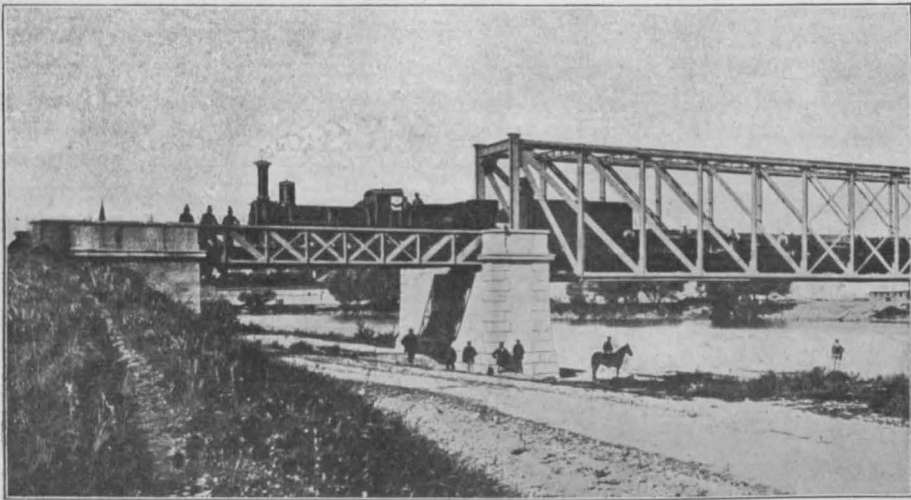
Eisenbahnbrücke über die Donau bei Ingolstadt. GERBER. 1868—1869.
